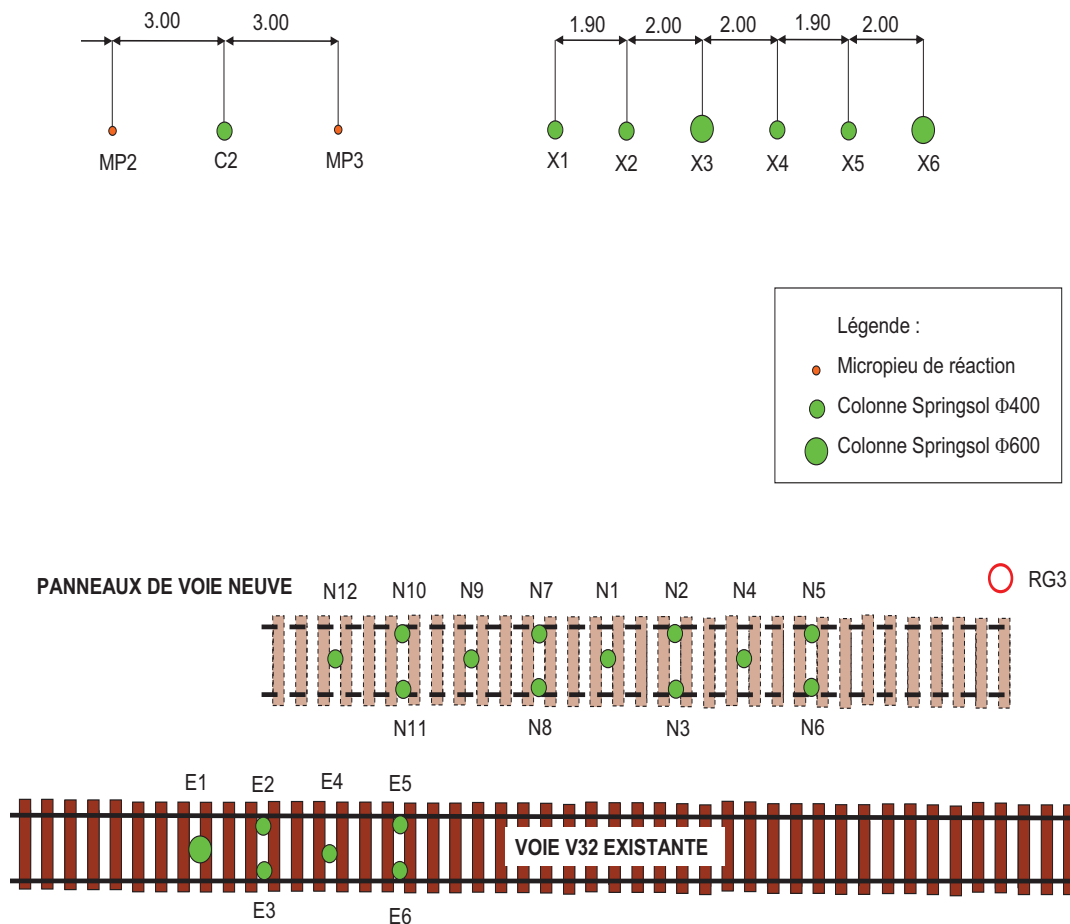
Plan d'implantation des colonnes sur le site de Vernouillet
